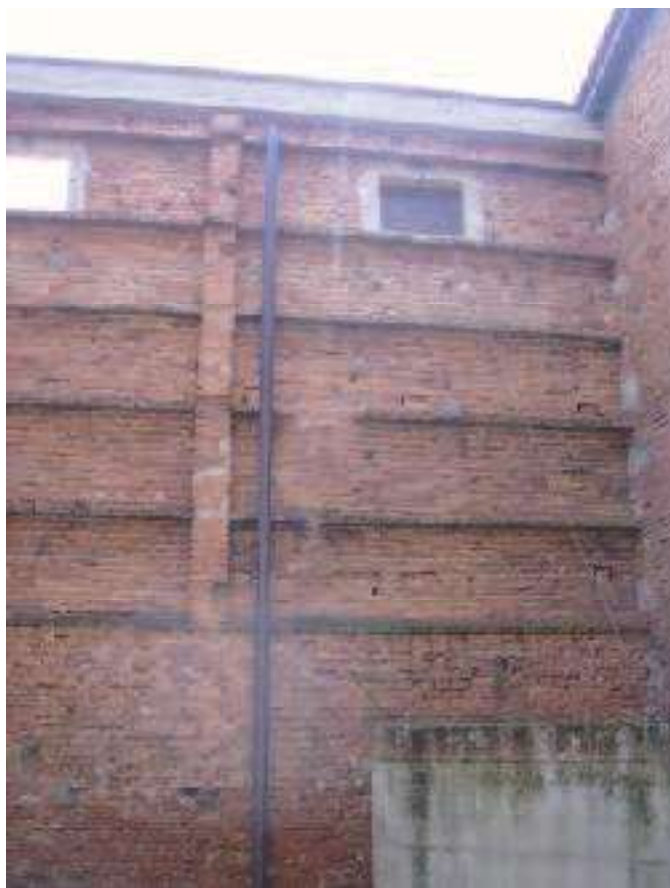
u.i. Sub.10 (corte) -lotto n.3 -
